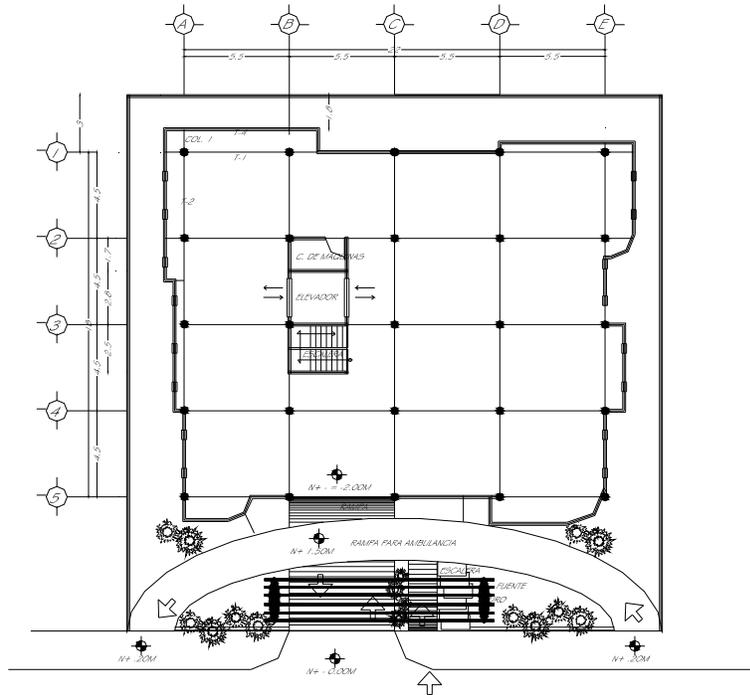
PLANTA BAJA ESTACIONAMIENTO N-2,00 m
